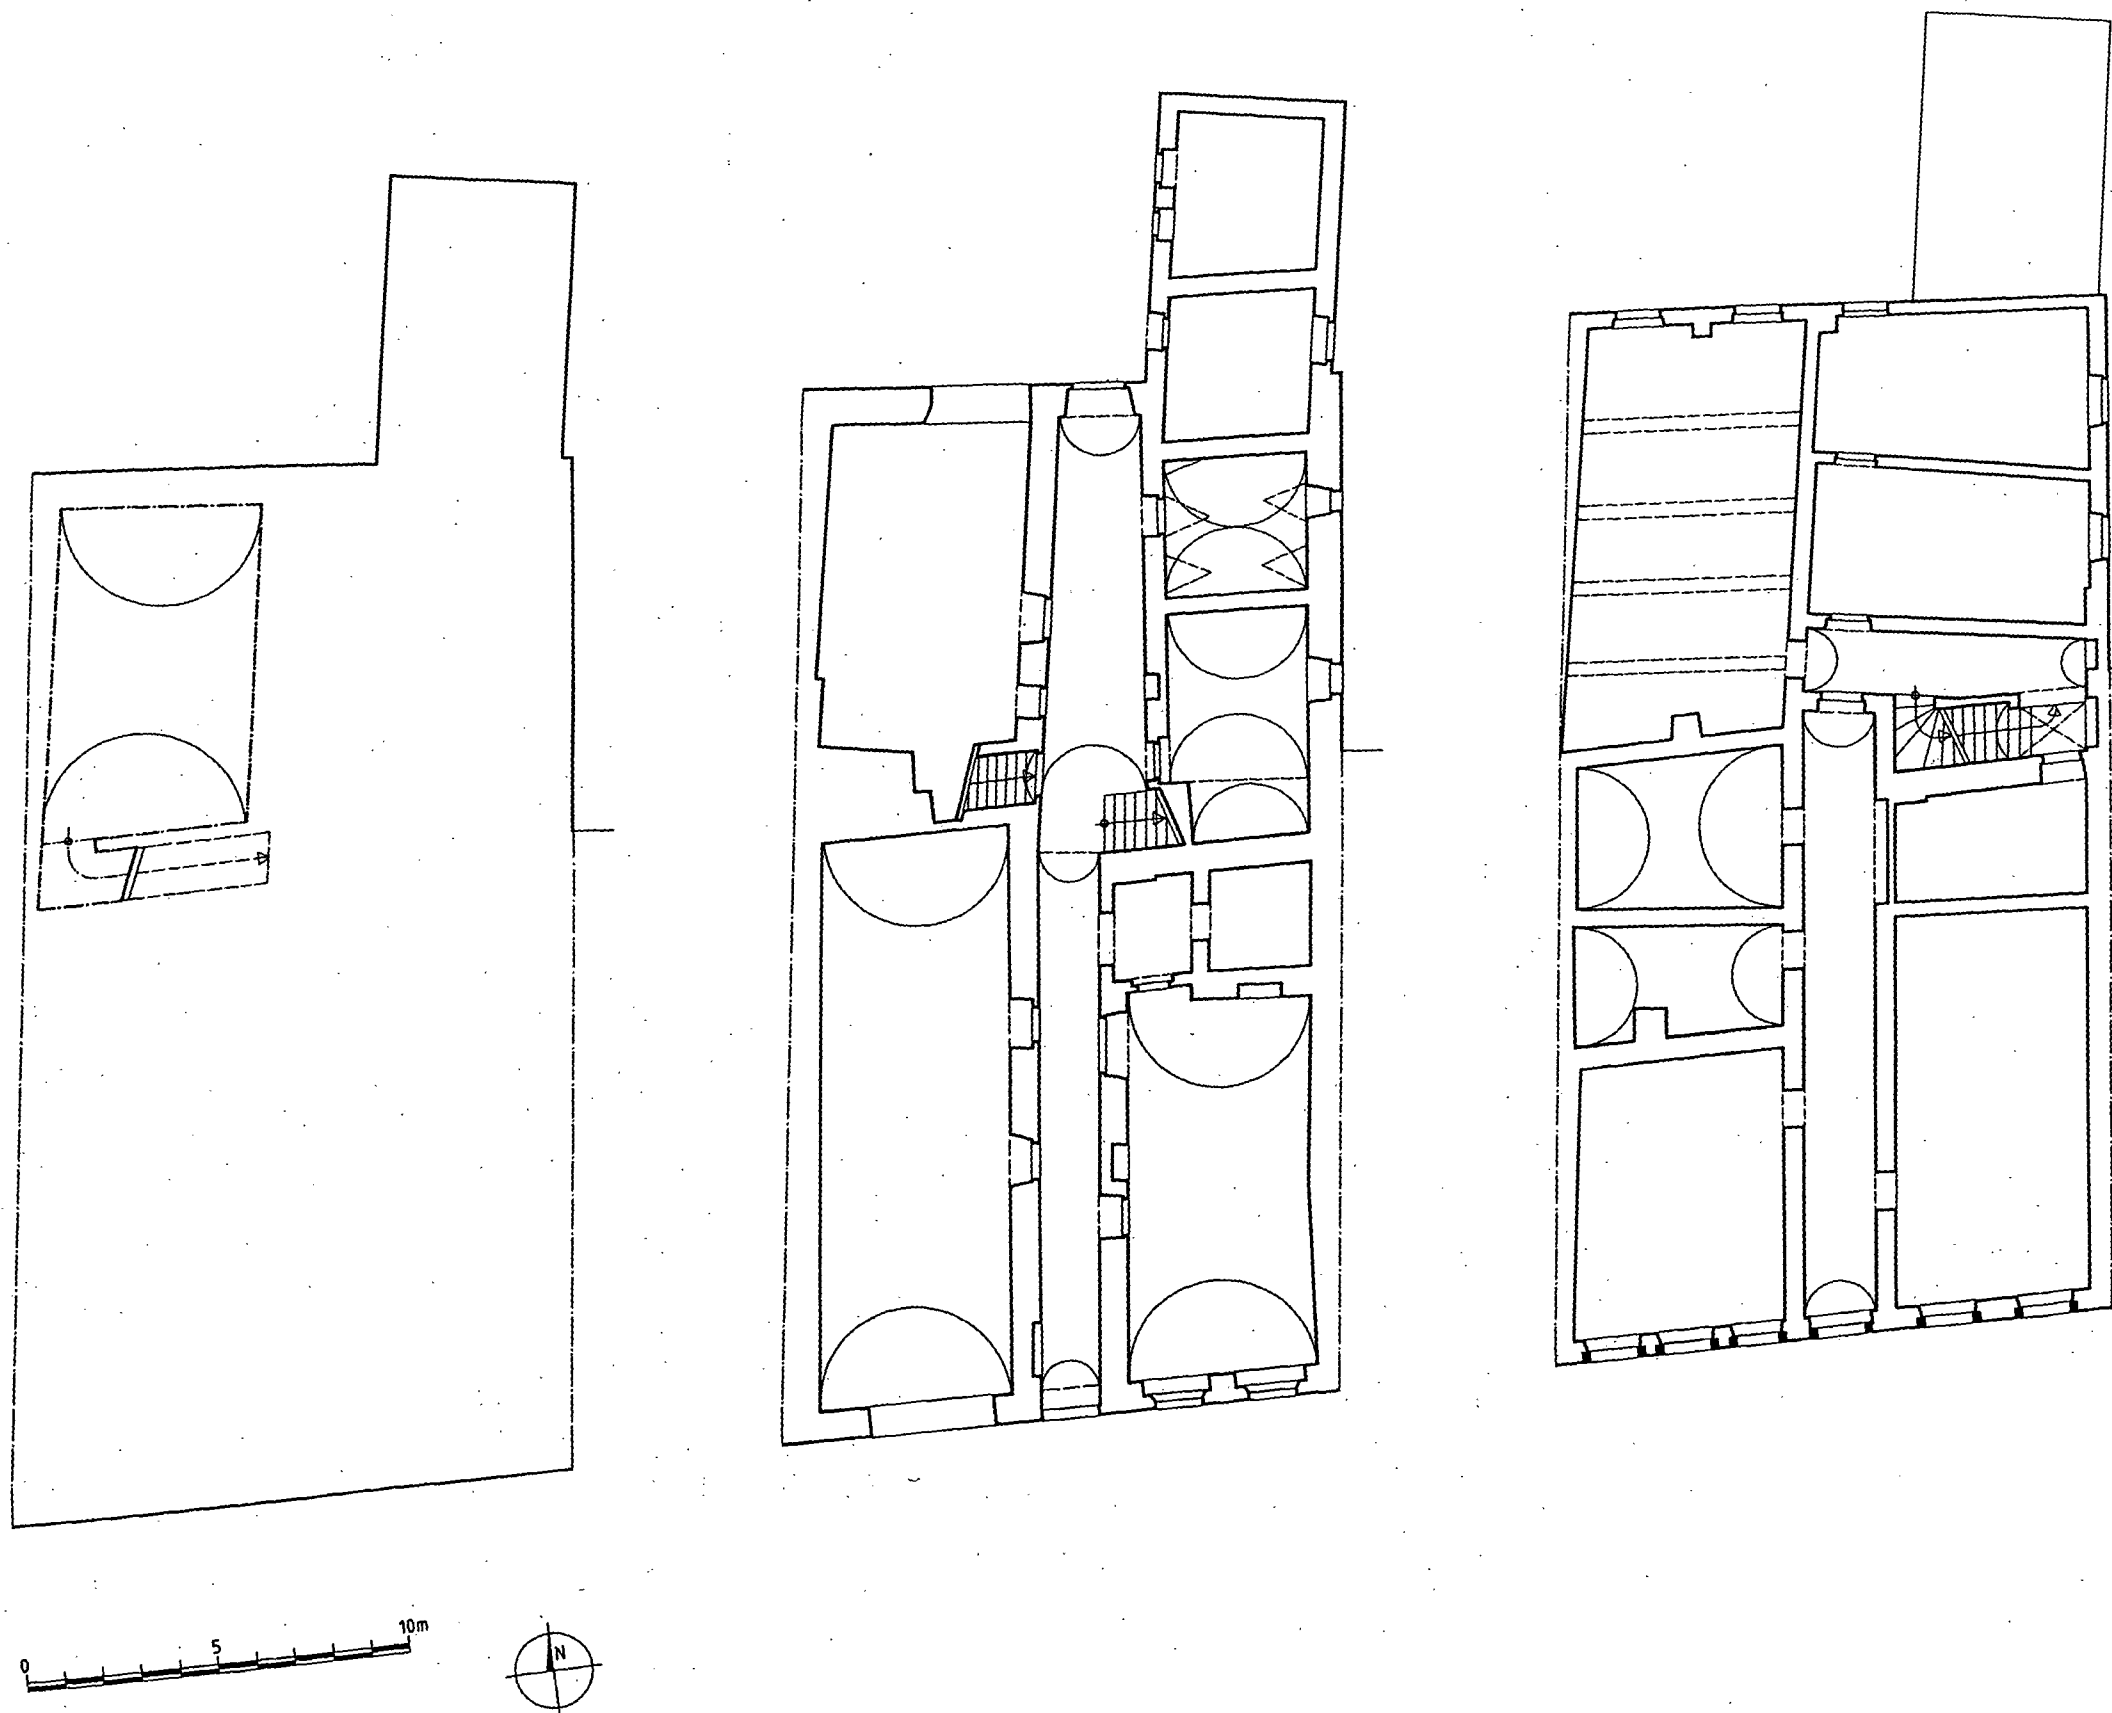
Schmiedstraße 12 – Grundrisse Keller, Erdgeschoss, Obergeschoss (1:200).
